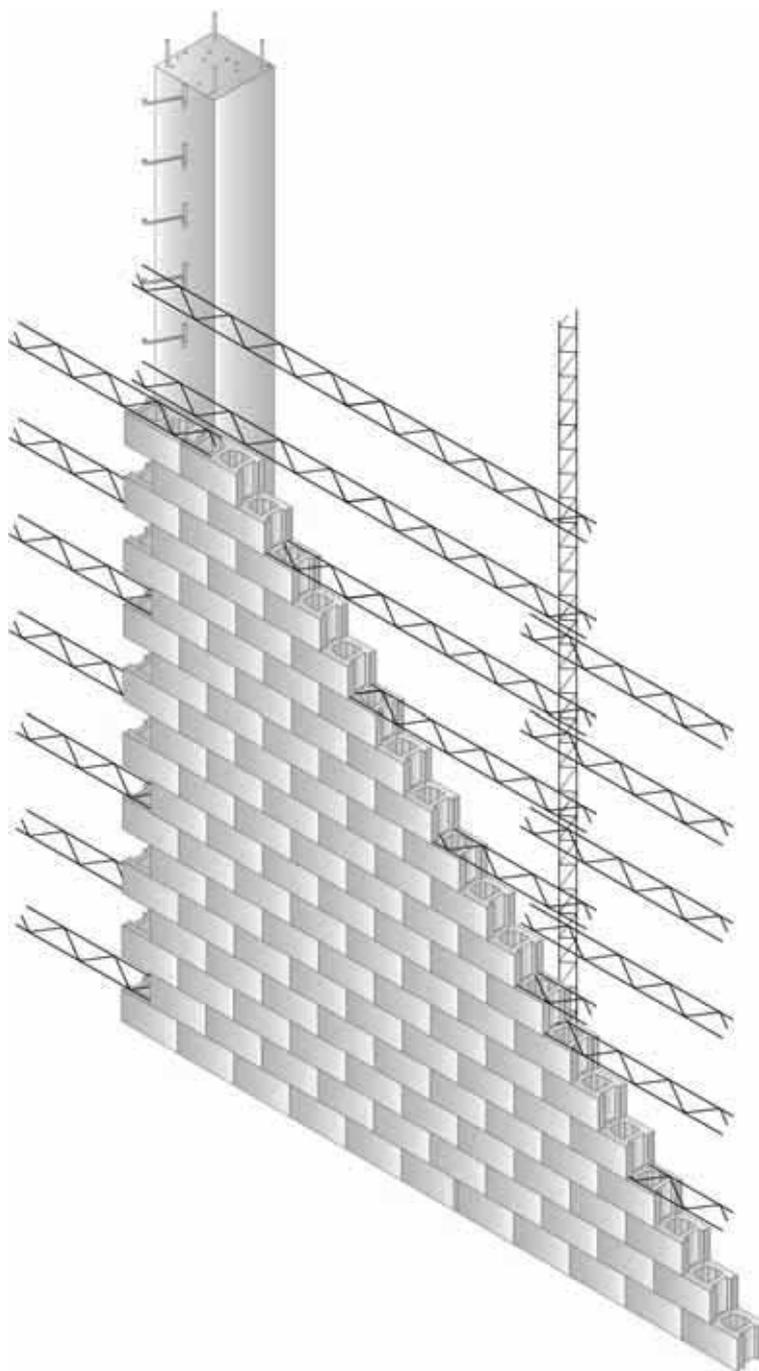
Muro de fábrica armada, armadura horizontal de tendel y armadura vertical con costillas.
